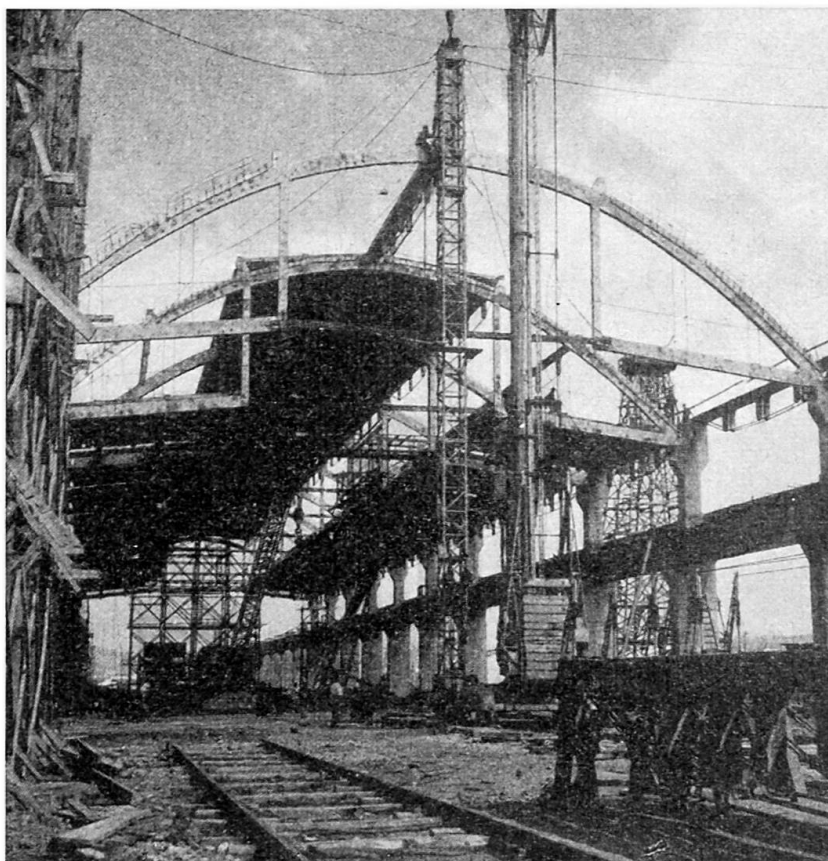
Montage des arcs et des poutres de la couverture de ENSIDESA (Avilés)
